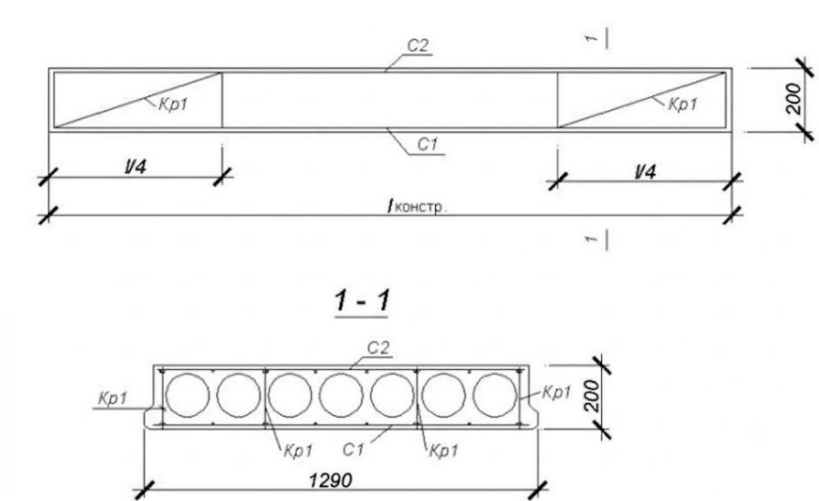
Армування плити перекриття з круглими порожнинами
